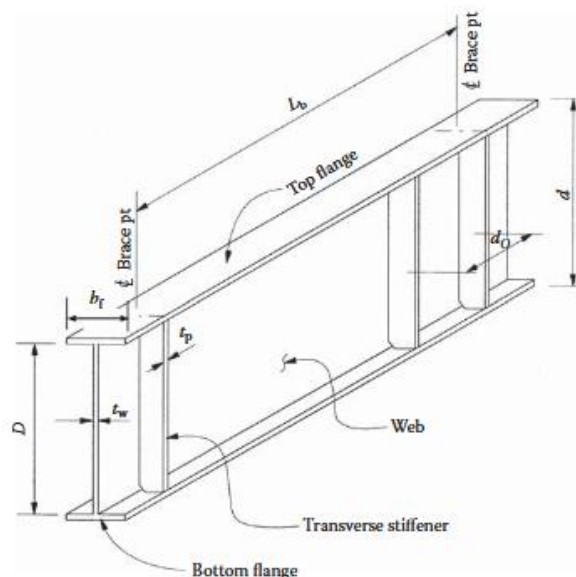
menunjukkan bagian tipikal dari superstruktur jembatan I-girder komposit. Komponen struktural utama meliputi pelat lantai beton, tiang geser, girder baja berpenampang I, pengaku longitudinal, pengaku transversal, dan rangka silang. Gambar 4.4 menunjukkan dimensi dan simbol yang digunakan untuk girder baja.
